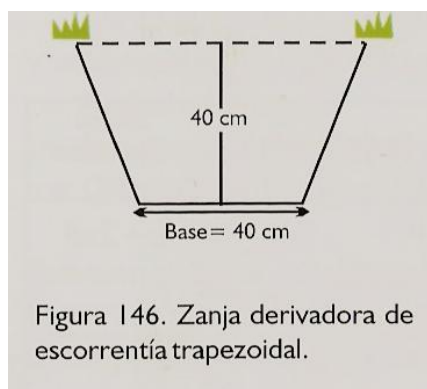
Zanja derivadora de escorrentía trapezoidal.
